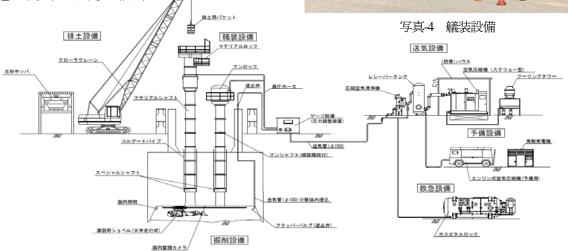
P2橋脚ニューマチックケーソン施工 設備概要図
